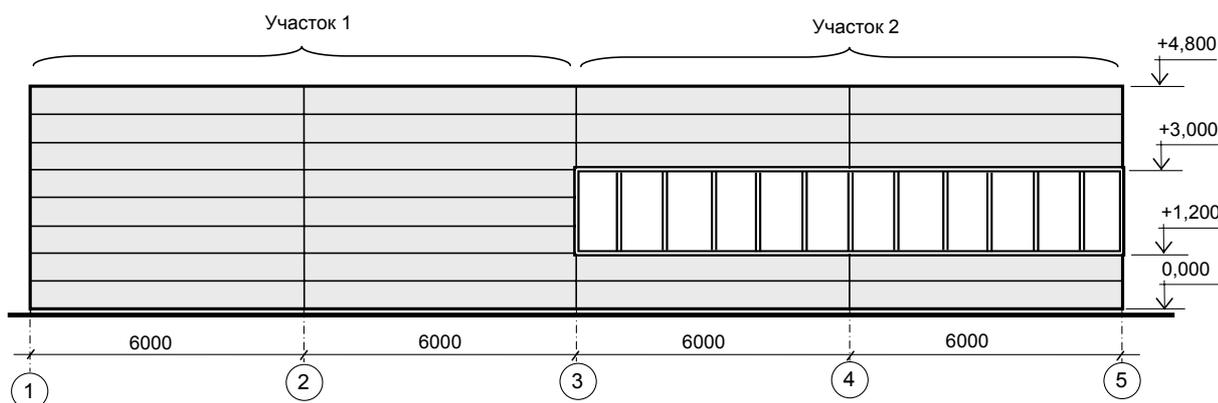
Схематичный фасад проектируемого здания (к примеру Е3)
